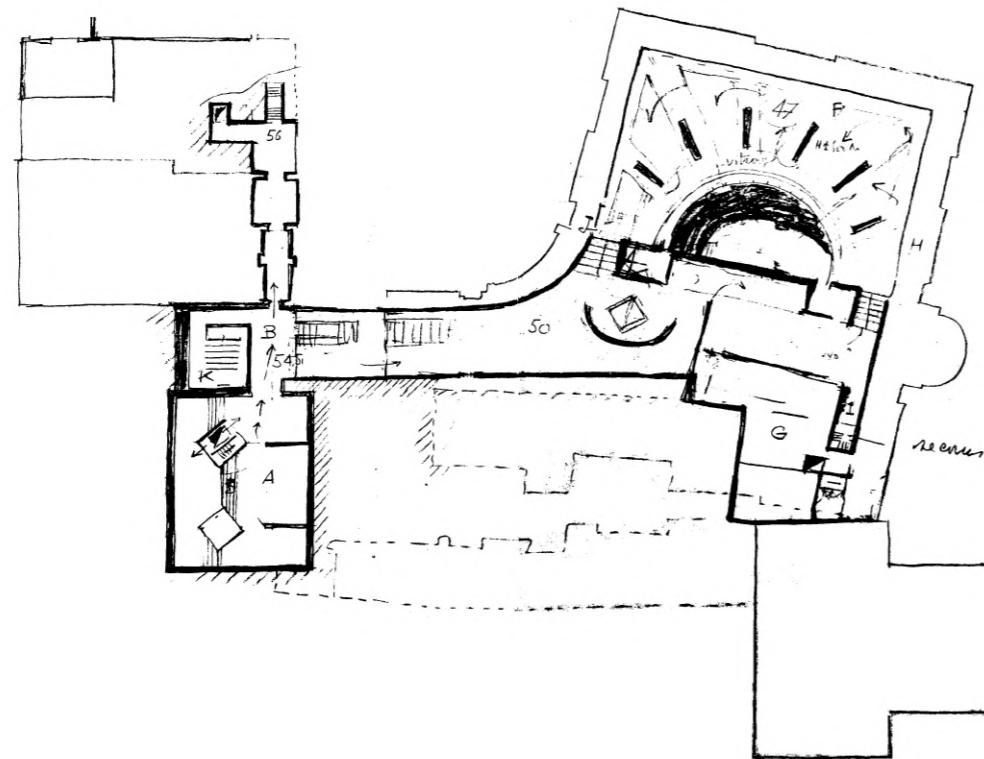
Plan des niveaux sous la rue du Musée et sous la place du Musée, ébauche du musée camouflé.
